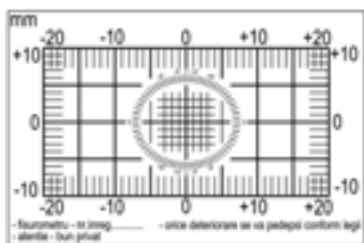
Fisuriometru – (desen autor) Fig. 5.38 - Detaliu privind amplasarea fisuriometrului – (desen autor)
